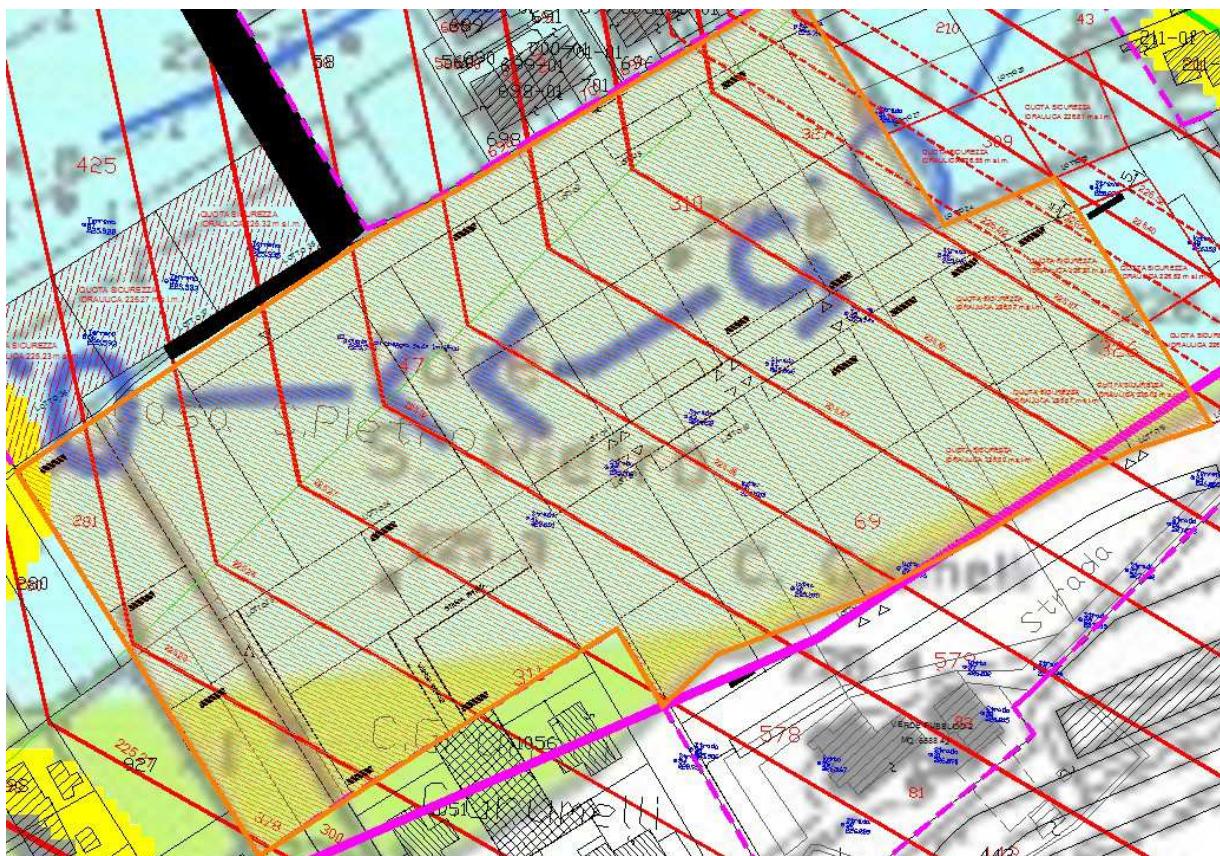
Planimetria della lottizzazione con indicazione della area soggetta a modifiche mediante la realizzazione delle opere di urbanizzazione.
